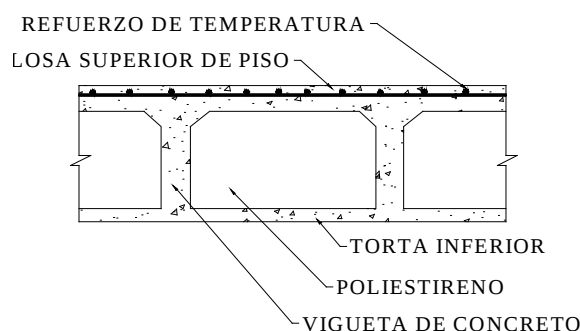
Sección típica del sistema de losa aligerada con poliestireno.
